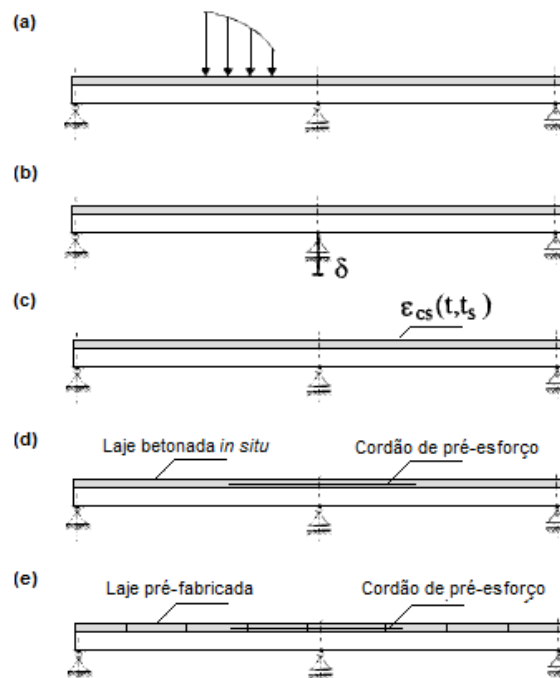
Diferentes acções na estrutura: (a) Acção estática; (b) Acção geométrica; (c) Retracção na laje de betão; (d) Pré-esforço na laje betonada *in situ*; (e) Pré-esforço na laje pré-fabricada. (Dezi, L *et al* 1998).
